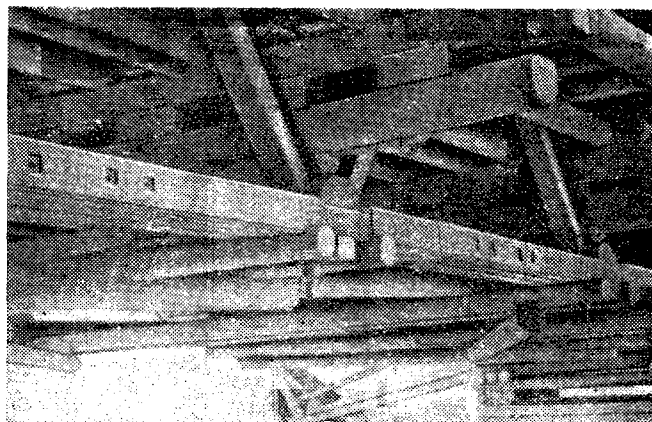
Усиление стыка нижнего пояса металлическими накладками на гвоздях
